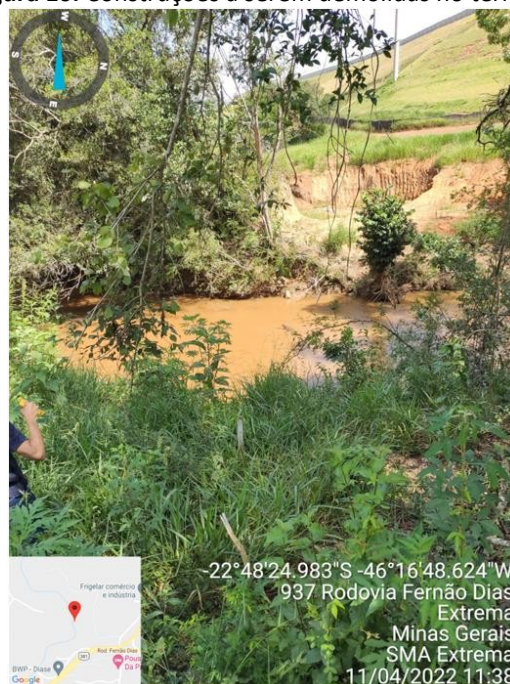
Área escavada na APP para implantação dos pilares de sustentação da ponte a ser construída
